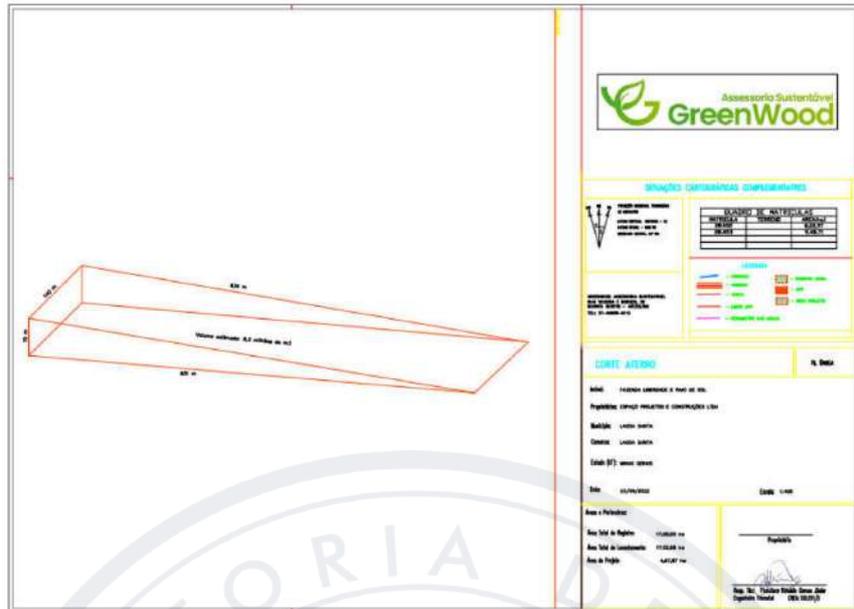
Planta do Projeto do Aterro\_ Seção. Fonte: Dados do empreendedor - Proc. 2202-24-LST-LIC (adptada)
